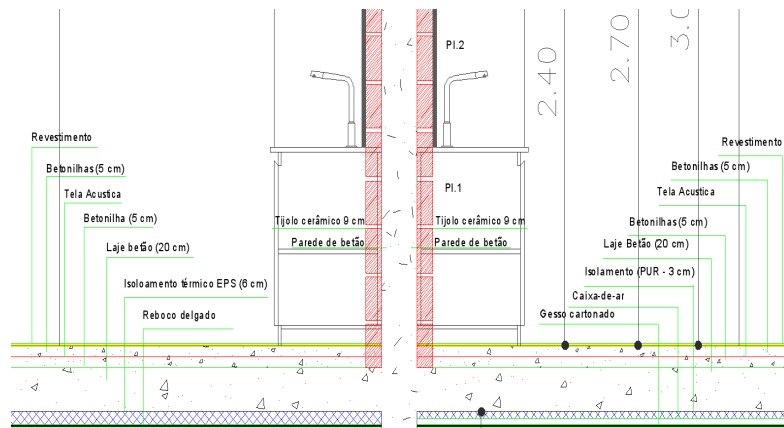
Solução Construtiva: Parede Interior- Separação Caixa de escada com WC)
